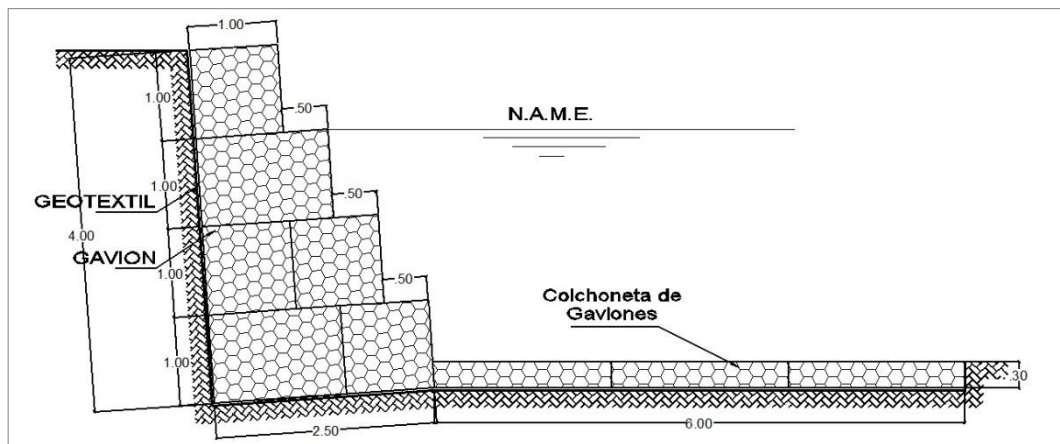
Sección propuesta de gavión, G-1B, h = 4.00 m y B = 2.50 m.
